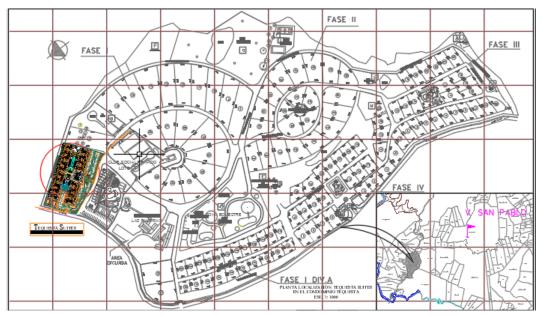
Ubicación Condominio Campestre Tequesta Fuente: Autores del Proyecto
